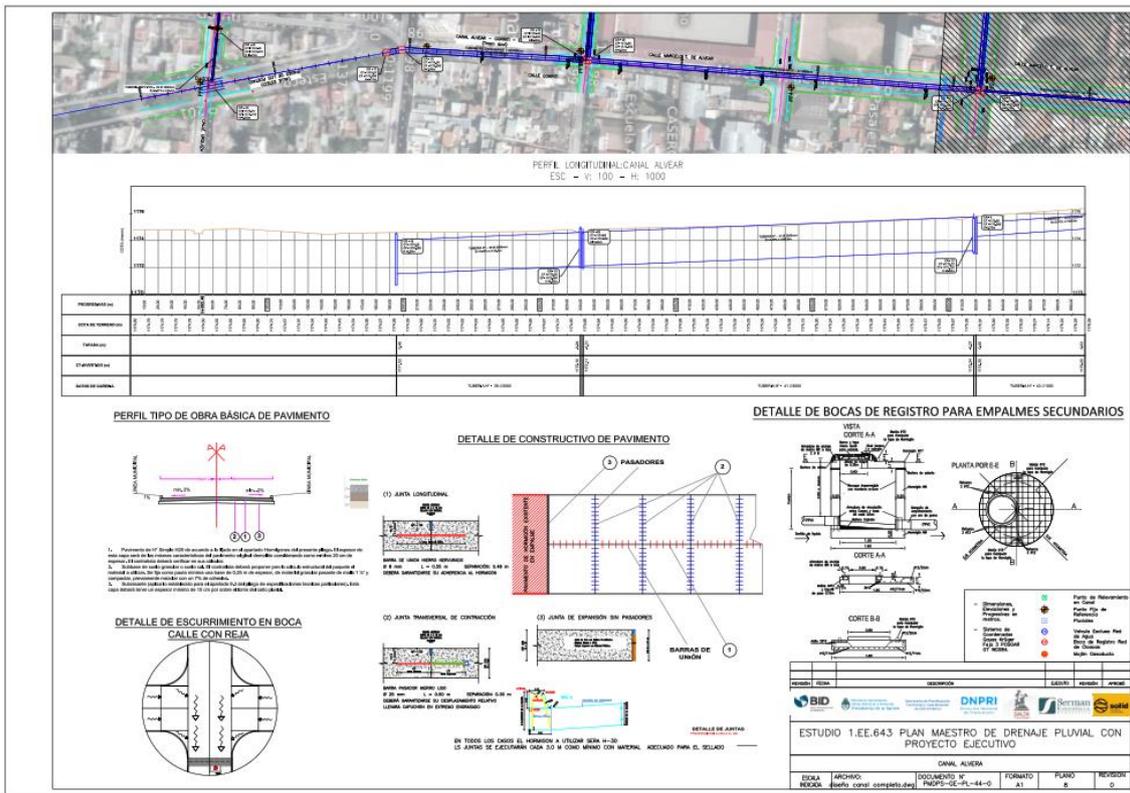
Plan Maestro de drenaje Pluvial – Canal Alvear
